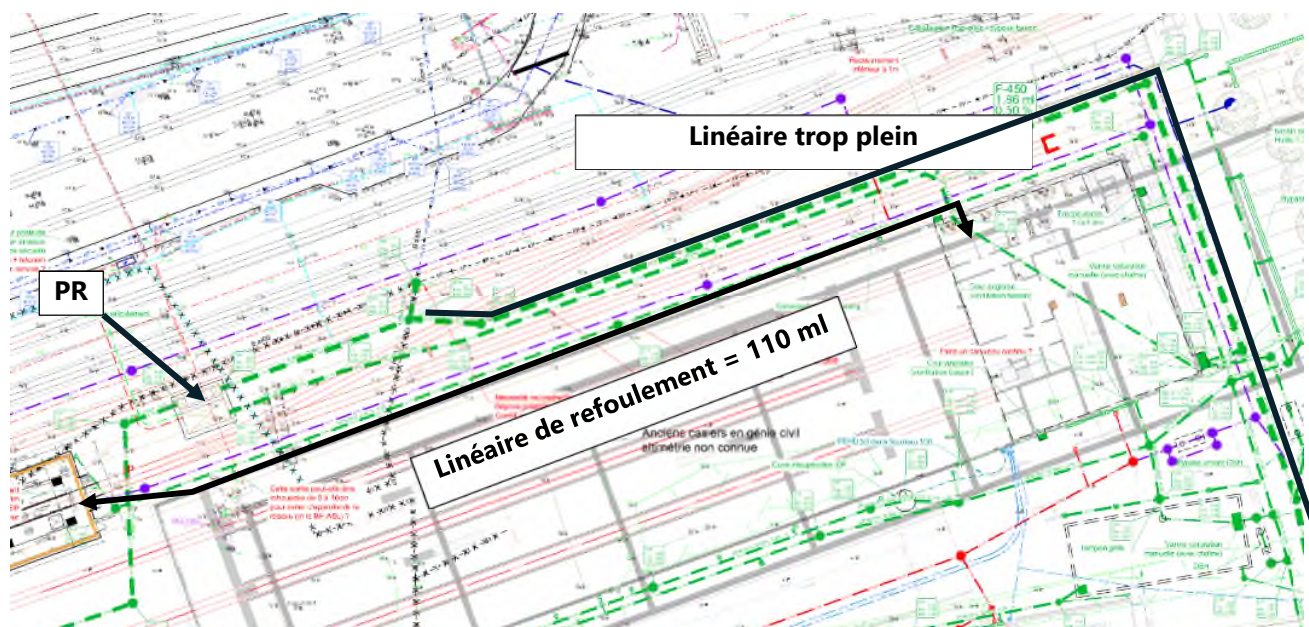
Extrait de la vue en plan, PLAN 3 RESEAUX EP PROJET PLAN A
